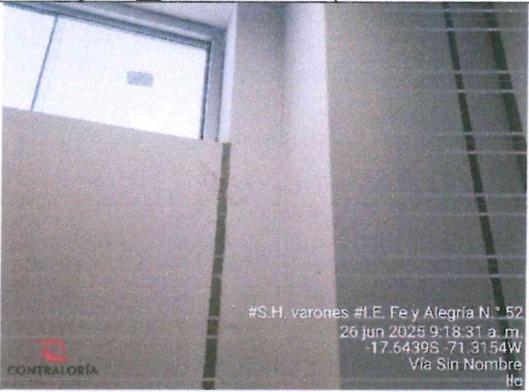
Fisura en unión muro-columna.
